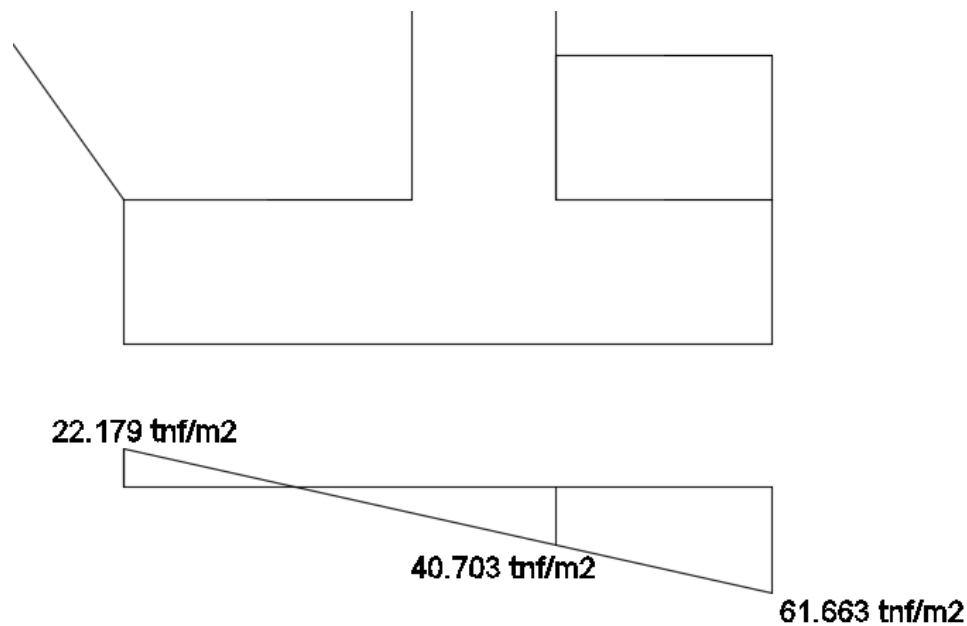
Esfuerzos dados en la base del Estribo (Fuente: elaboración propia)
